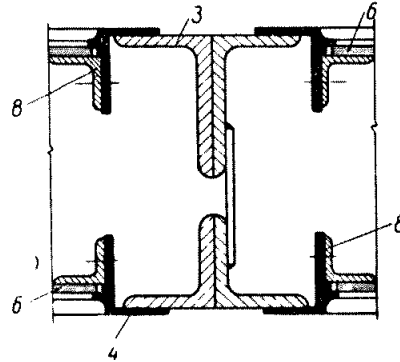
Проем в наружном стекложелезобетонном ограждении
